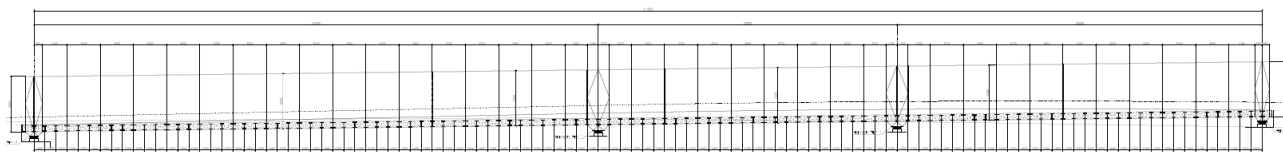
Sezione impalcato manufatto di scavalco su linea RFI.
